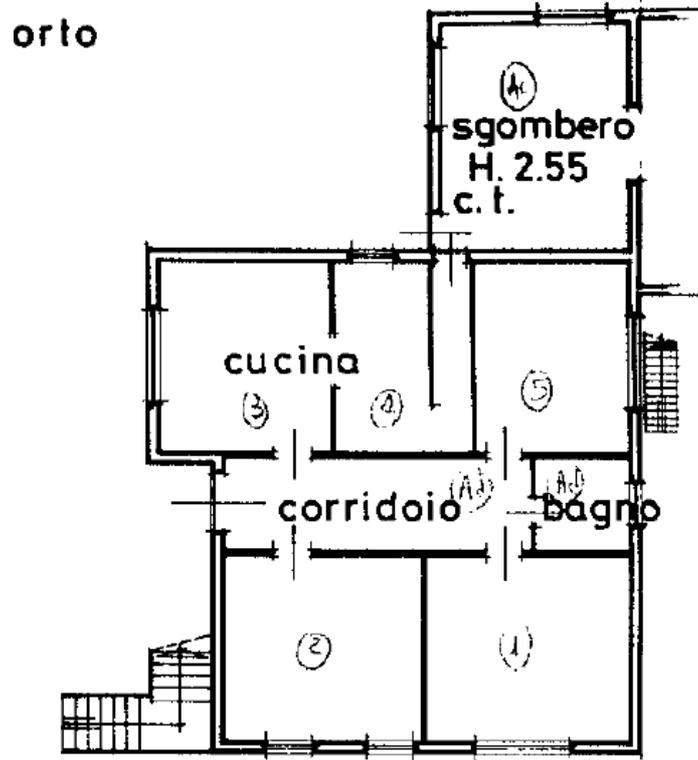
Estratto della planimetria catastale – sub. 1, p.t.
